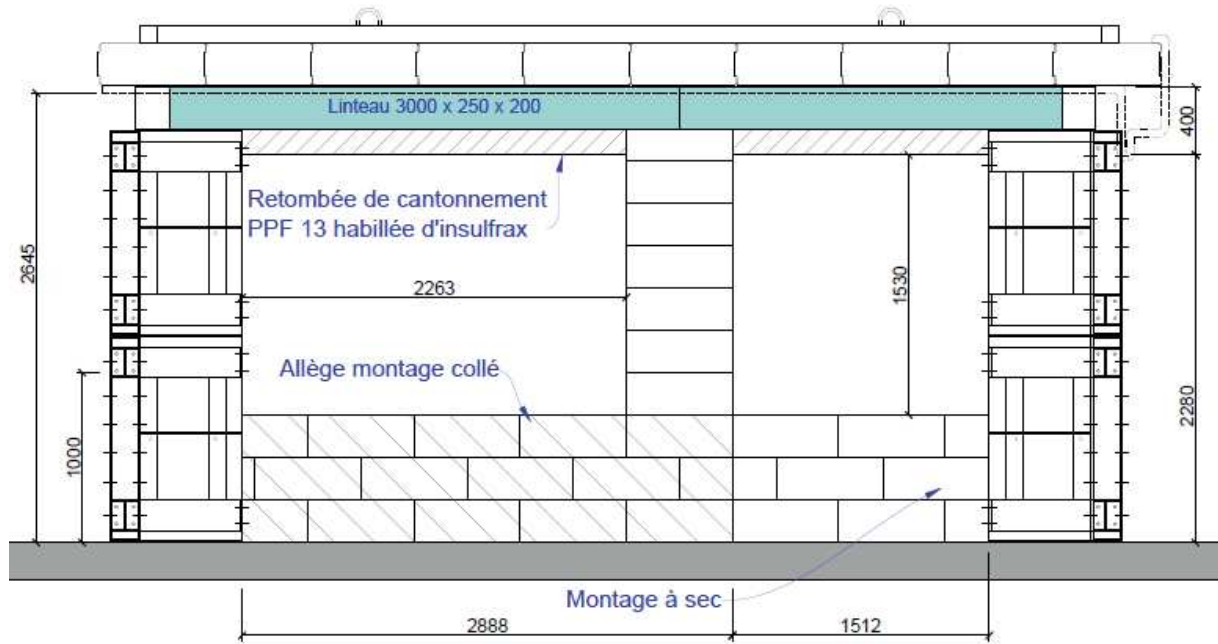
Élévation Sud de la cellule d'essai pour l'essai 3 (poteau/poutres LC)
